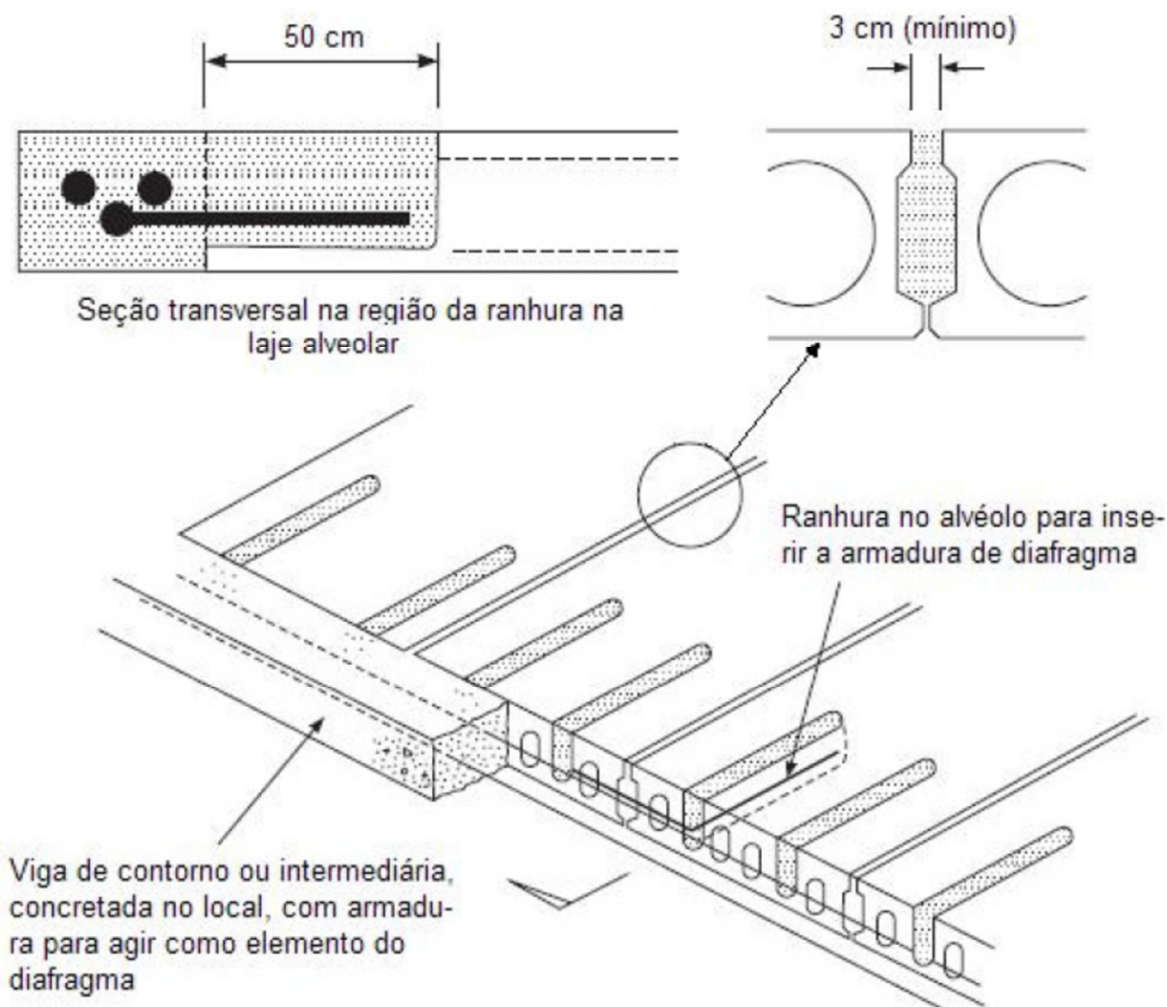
Pavimento preparado para receber a capa estrutural.
